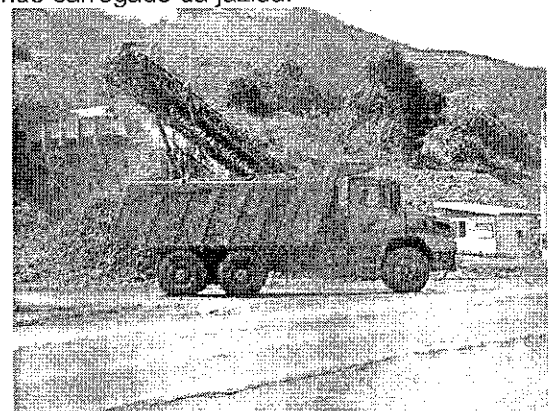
Lote 03/RS – Bota-Fora AB, Área B, Km 65.
